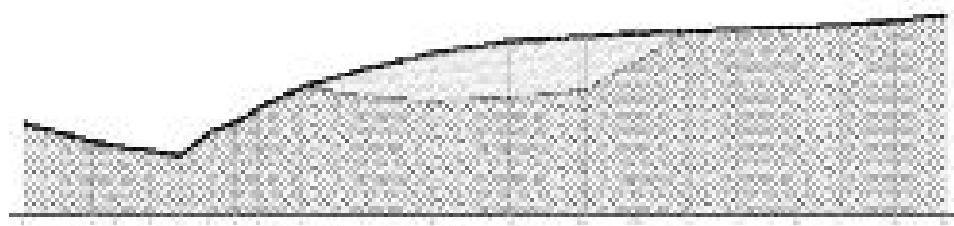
Sezione con indicata la zona oggetto di coltivazione (non in scala).
